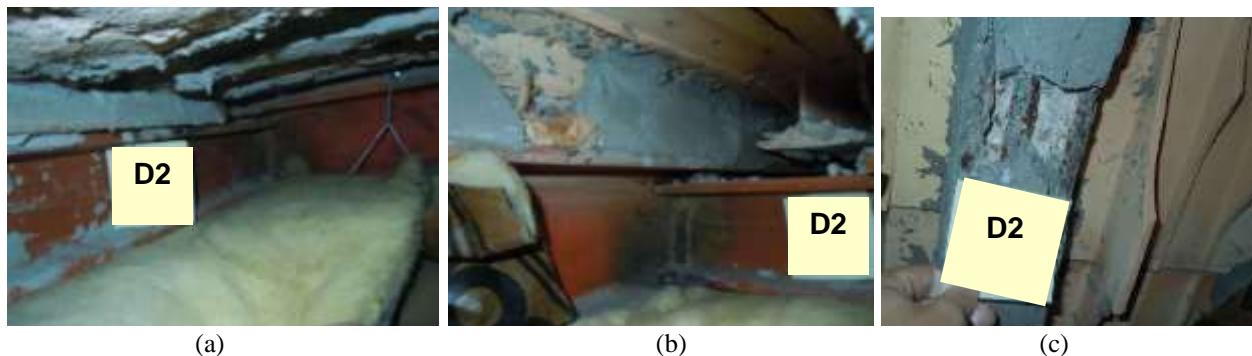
Rimozione del controsoffitto fisso D2 ed esame visivo sul solaio di copertura del 4° piano: (a), (b) doppia orditura di putrelle in ferro al di sotto del solaio latero-cementizio; (c) individuazione delle barre del solaio.
